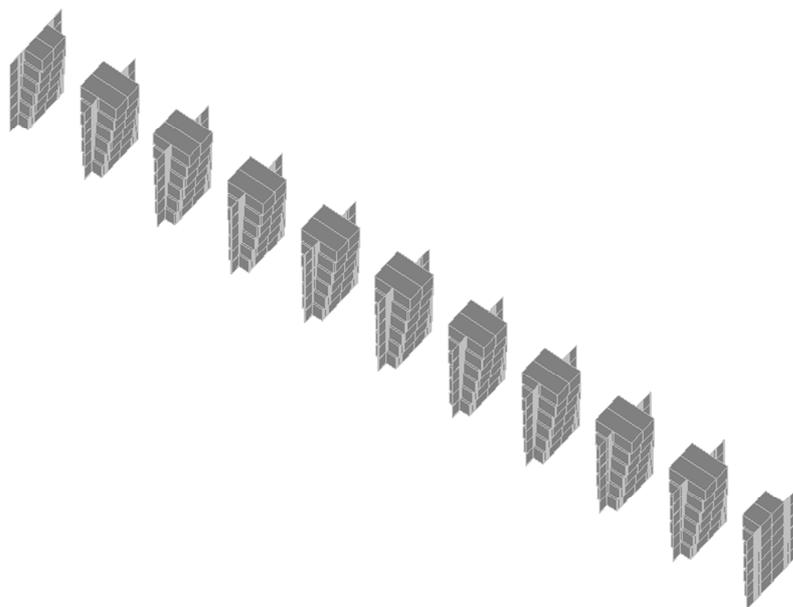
Поперечные ребра железобетонной балки ростверка с разными жесткостями
